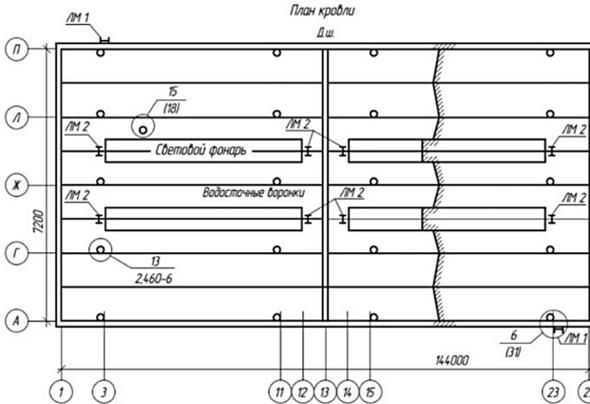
План кровли многопролетного одноэтажного промздания
